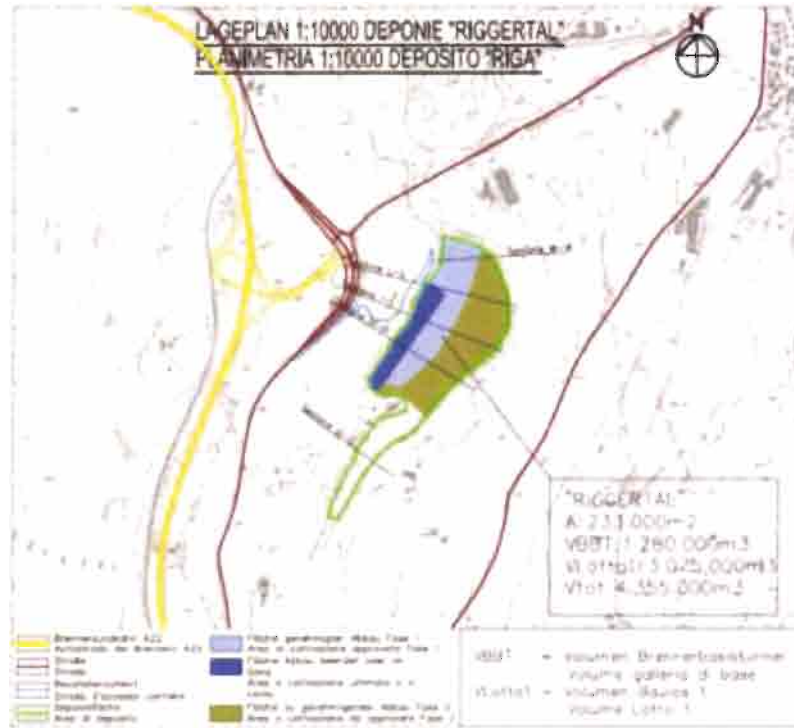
Vorprojekt – Standort Riggertal: Endgültiger Lageplan unter Umsetzung der Auflagen MATT 2004
